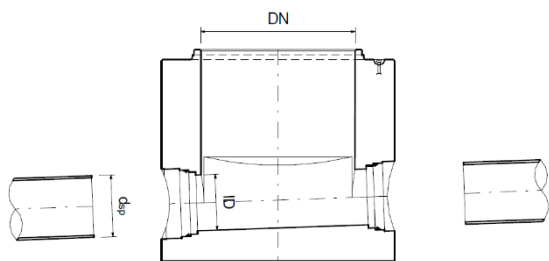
Anschluss mit Steinzeugrohre Typ H mit Gefälle J ≤ 500 ‰. AQUIME QUEDE
